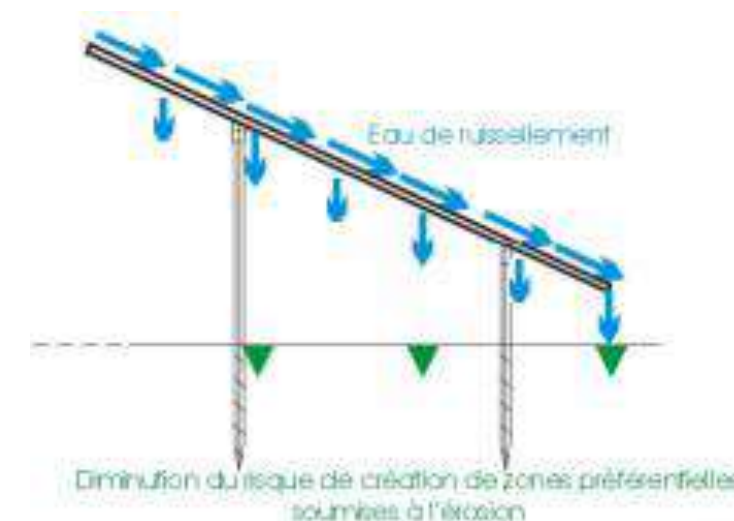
Schéma de principe des écoulements d'eaux pluviales sur les panneaux – effets des structures supportant des panneaux disjoints
